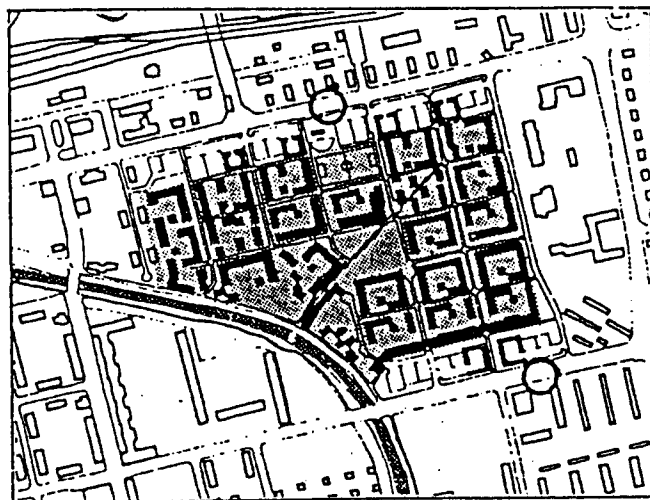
Plan de Bruket, Scanviken : Architecte : R. ERSKINE
